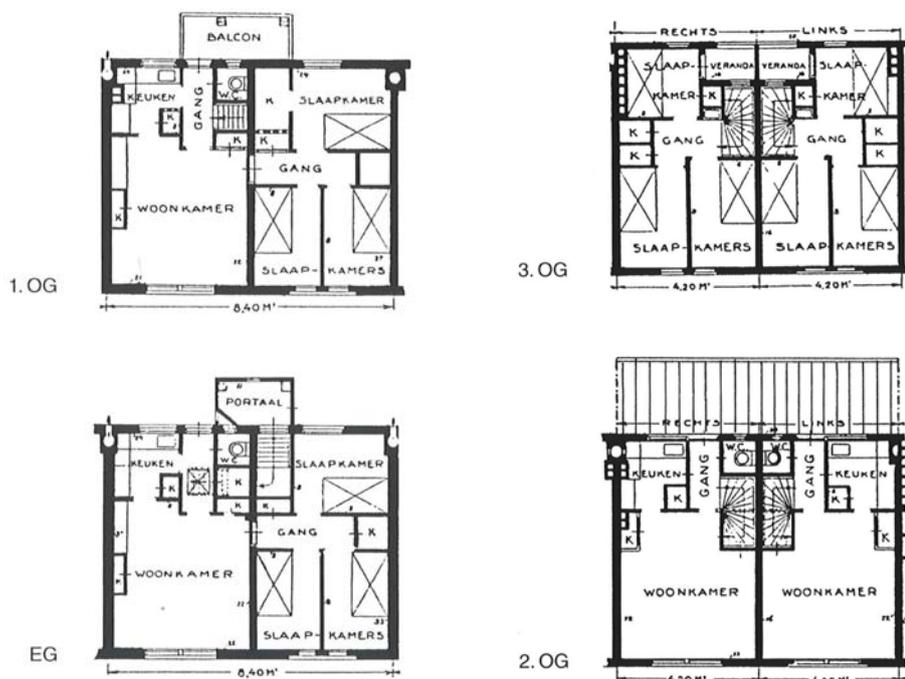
Grundrisstypologie Wohnanlage Spangen
